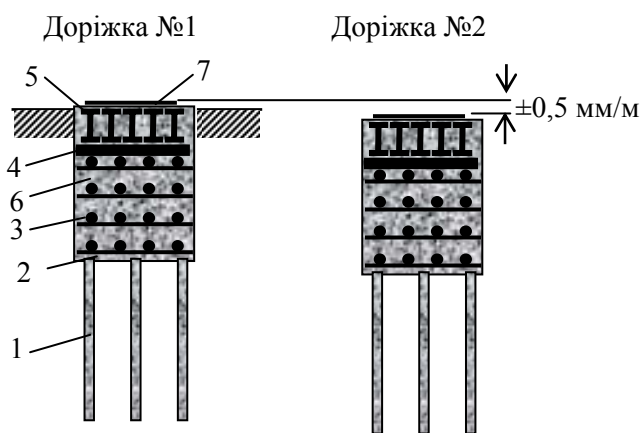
Конструкція накочувальної доріжки: 1 – залізобетонні палі; 2 – бетонна подушка; 3 – арматурний каркас; 4 – металева шпала з швелера; 5 – двотаврові балки; 6 – бетон; 7 – металевий лист
